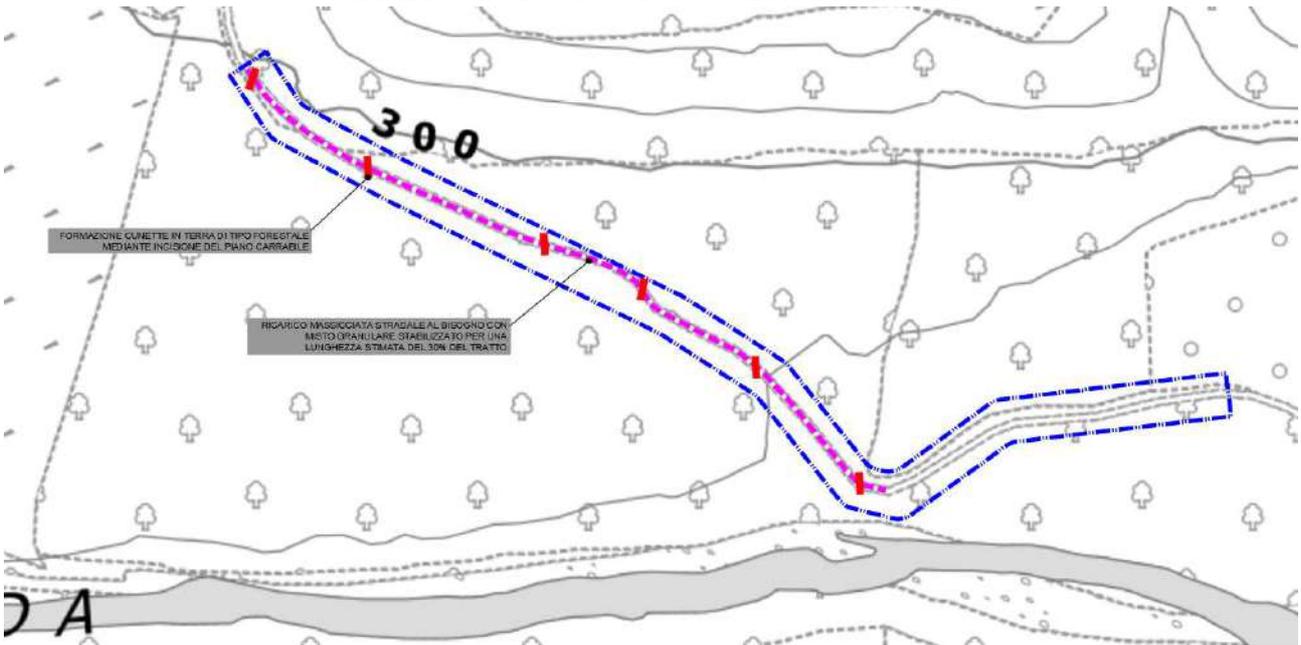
Planimetria di progetto. (rappresentazione non in scala)
